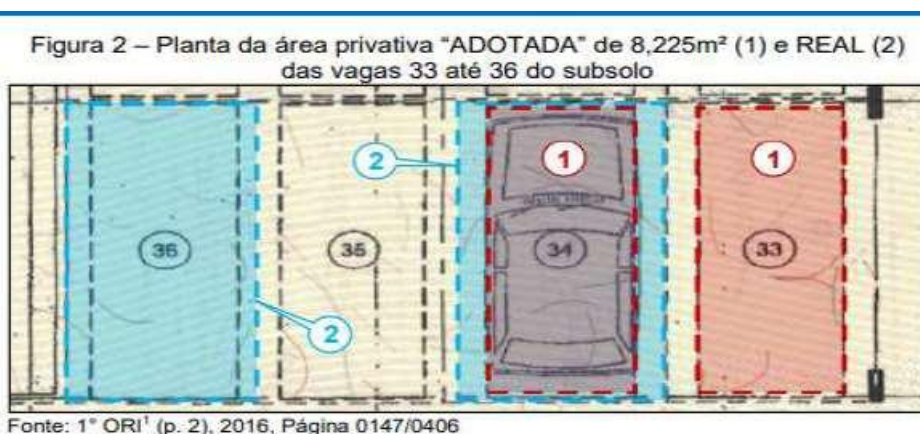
Recorte da Planta da área privativa adotada e real apresentada pela requerida.
